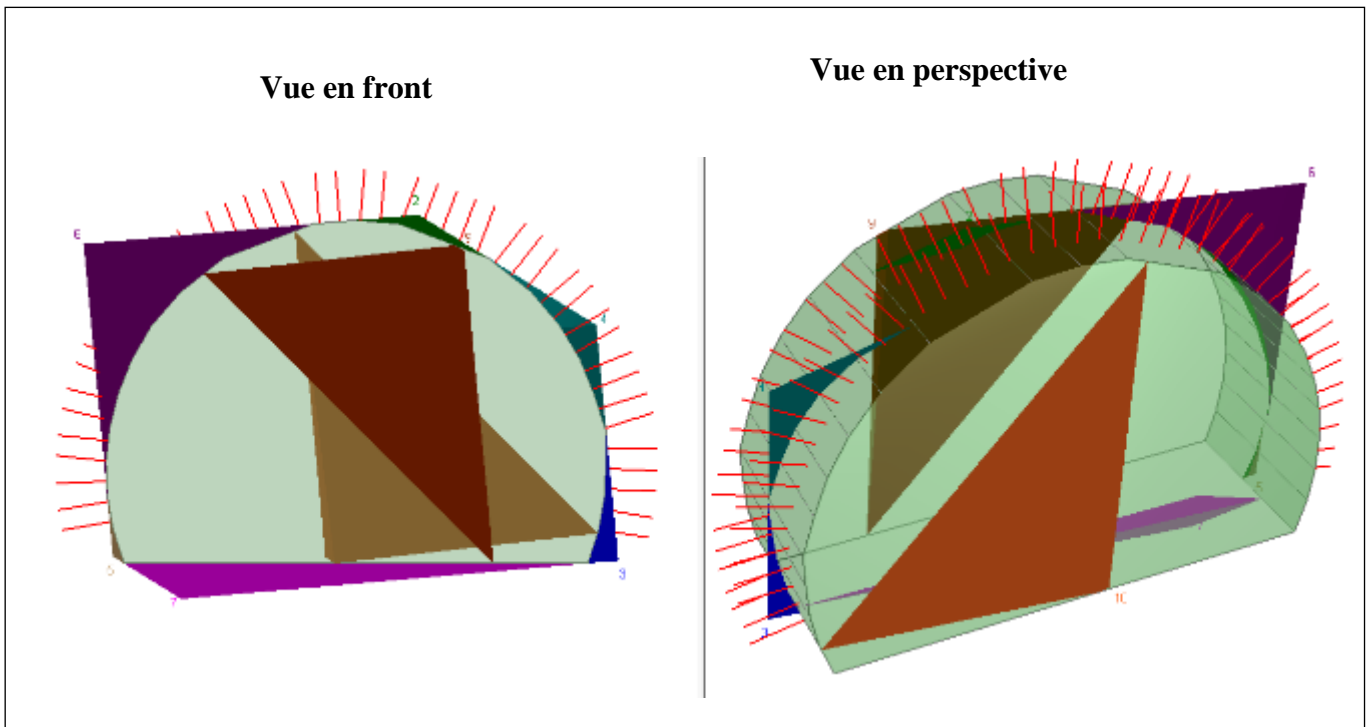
Exemple d'étude de stabilité après la mise en place du soutènement
